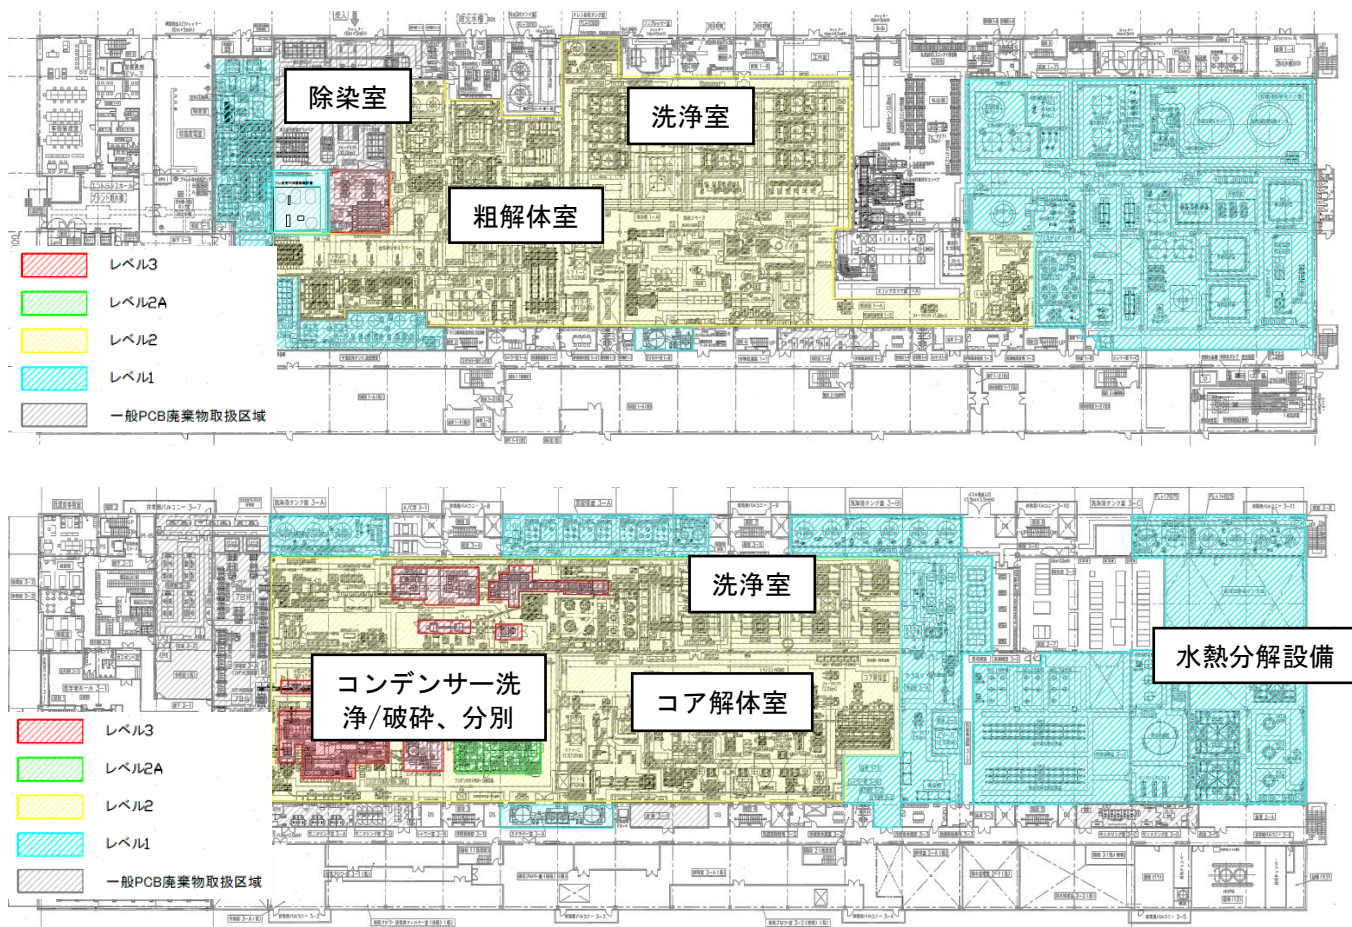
東京事業所の平面図（上図 1 階、下図 3 階）
